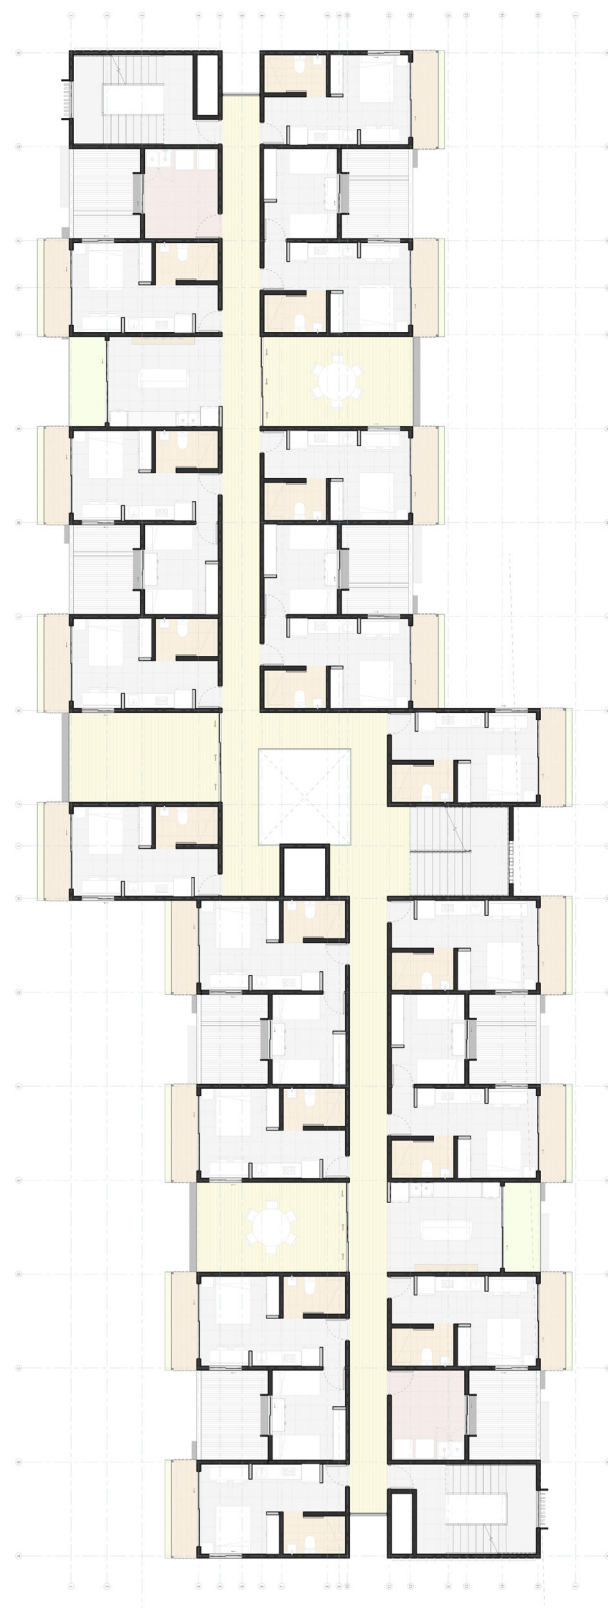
Planta de distribución arquitectónica ampliada tipología de cuartería, nivel 3 y 5.
